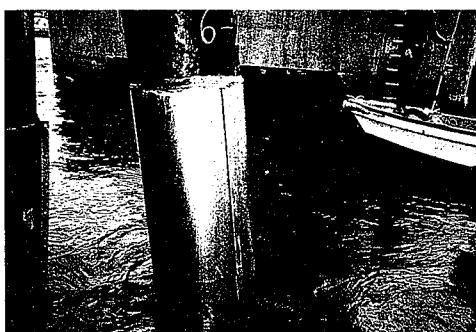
TP工法施工例(日鉄鉱業/鳥形山鉱業所)
